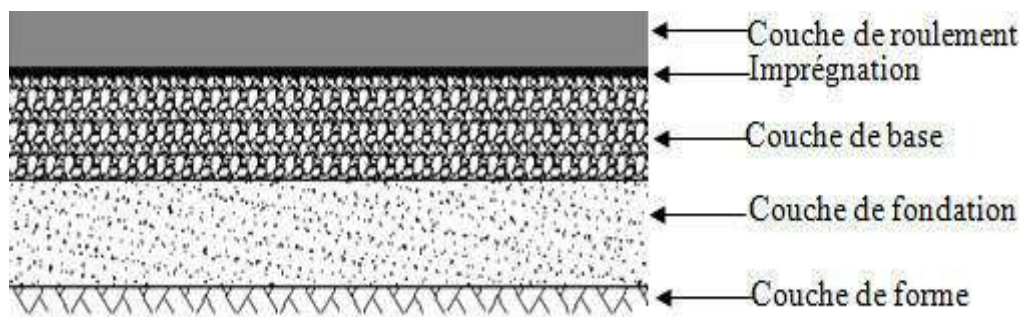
Coupe transversale type d'une chaussée saharienne.
